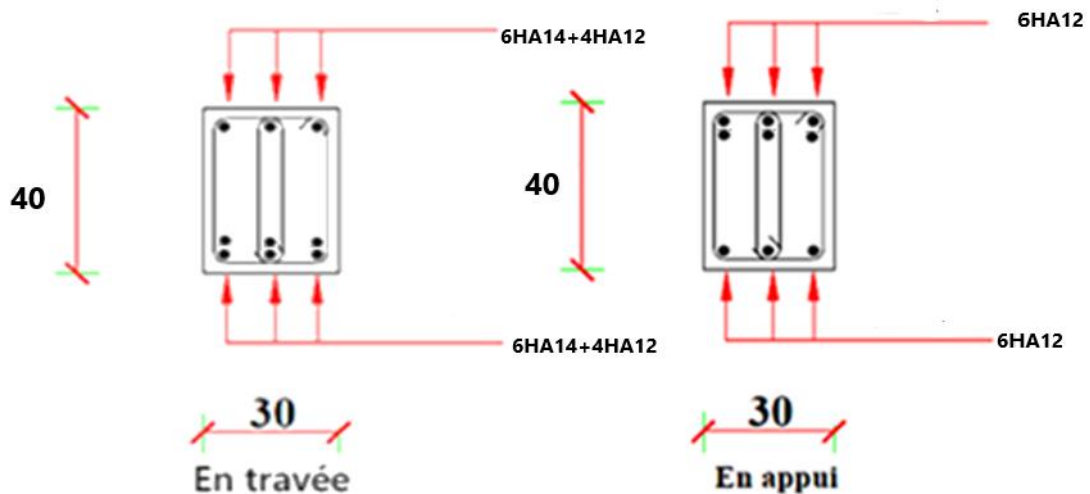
SCHEMA DE FERRAILAGE DE LA POUTRE SECONDAIRE
